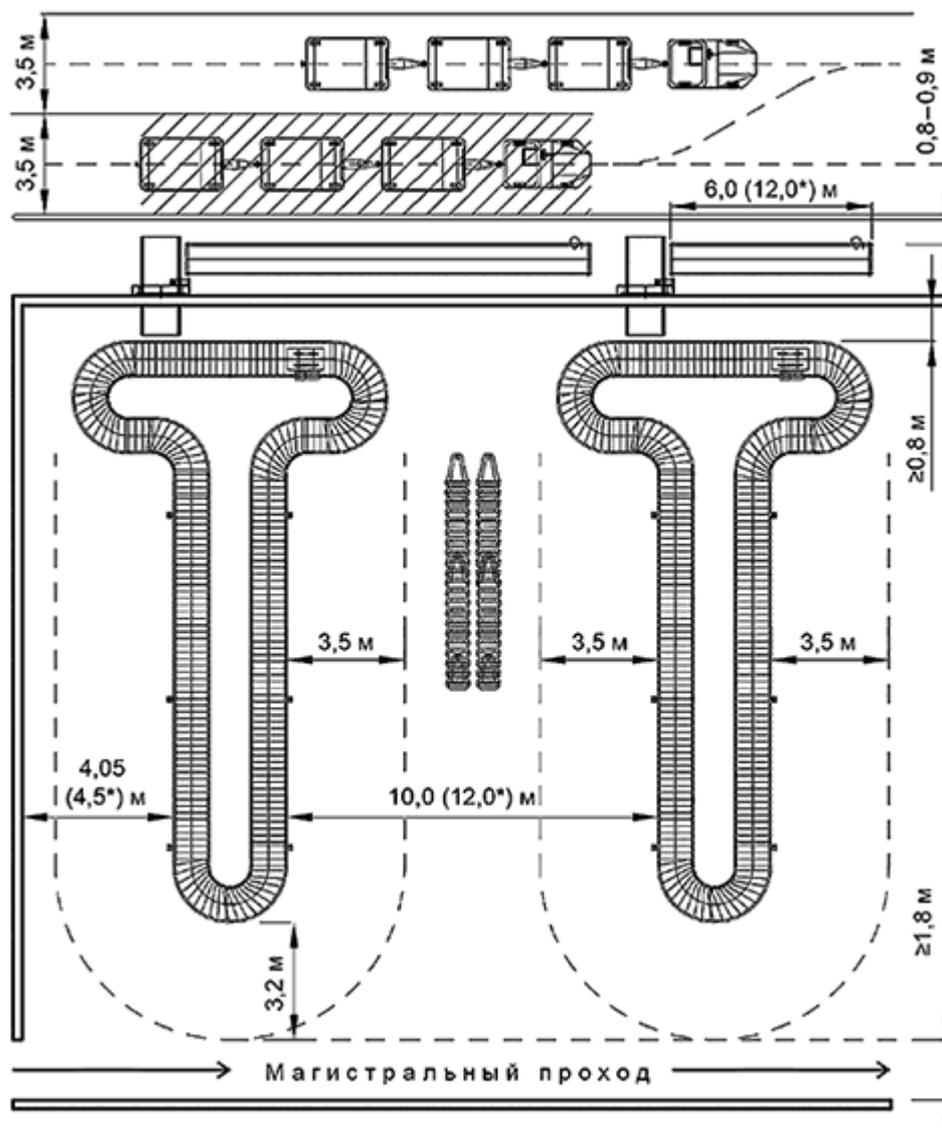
Минимальные габаритные размеры зоны обработки и сортировки багажа
